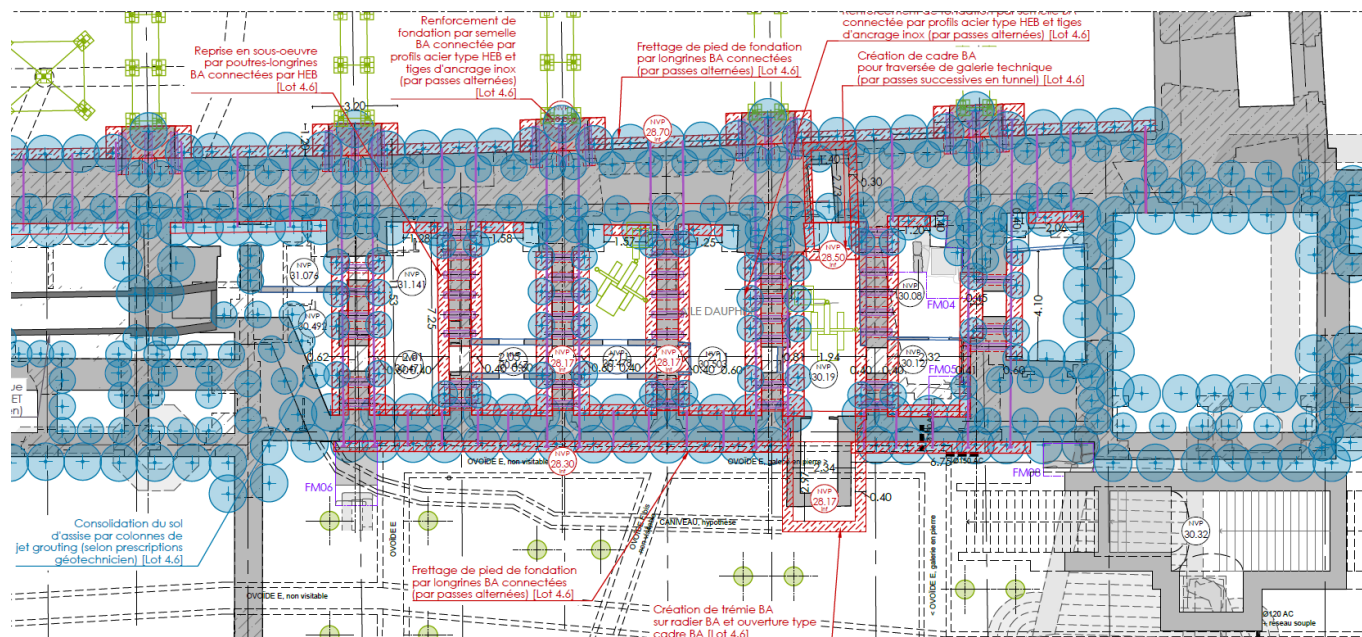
Plan de principe de l'implantation des colonnes de jet grouting au droit de la façade Sud (Galerie Dauphine)
